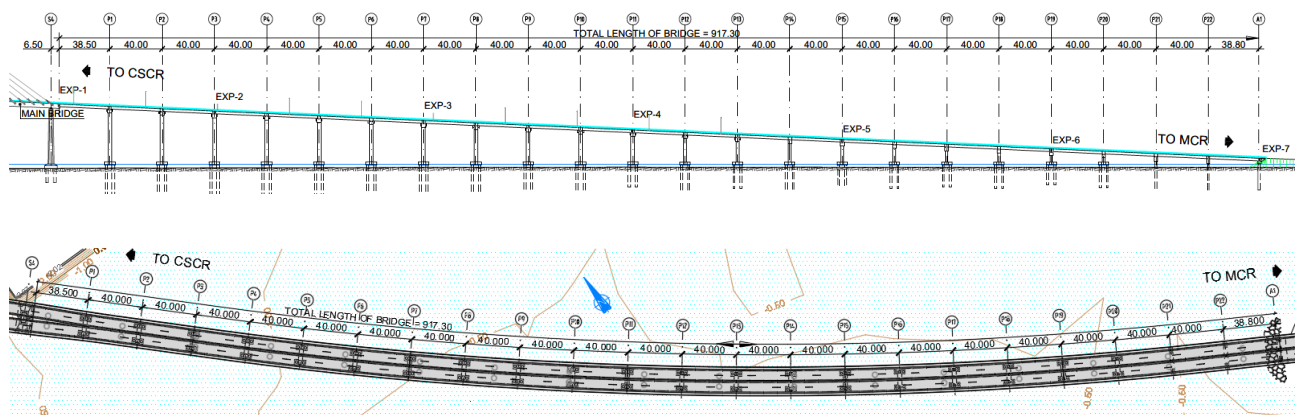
Vista en alzado y planta del Viaducto de Cordova
